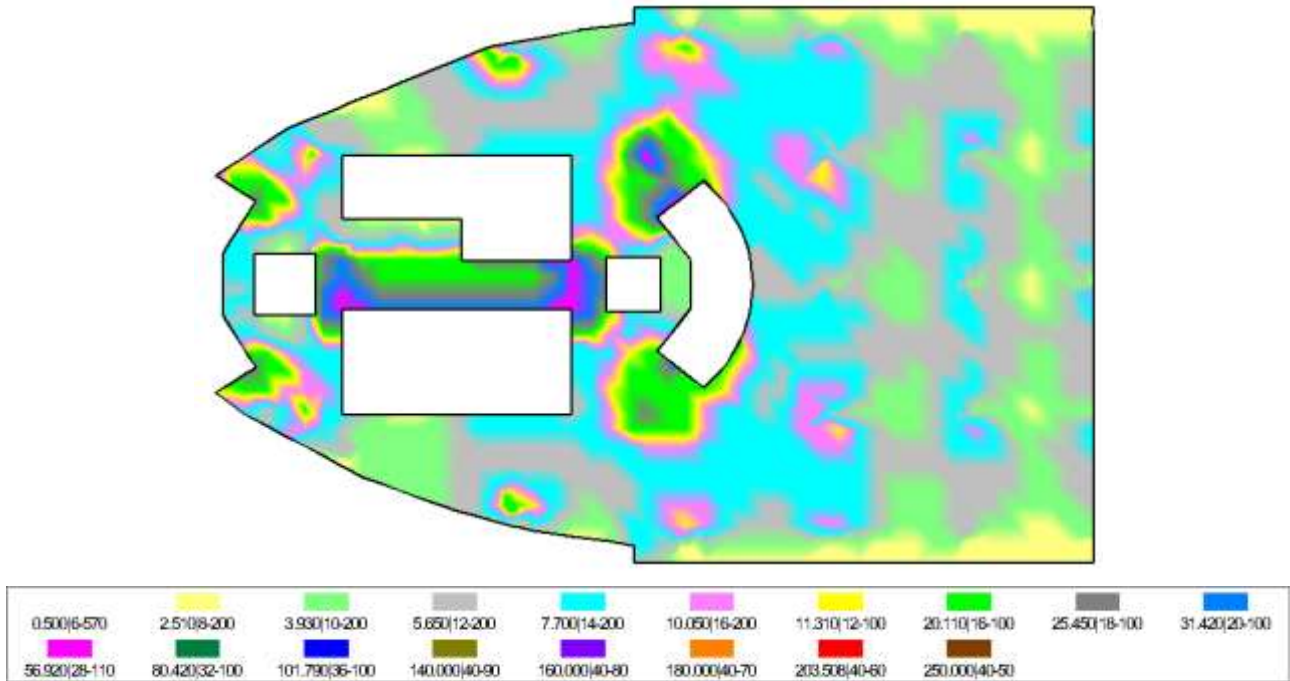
Армирование плиты перекрытия восточной башни на отм. +42,80 м. Нижняя продольная арматура в направлении оси S, см²/м [15]
